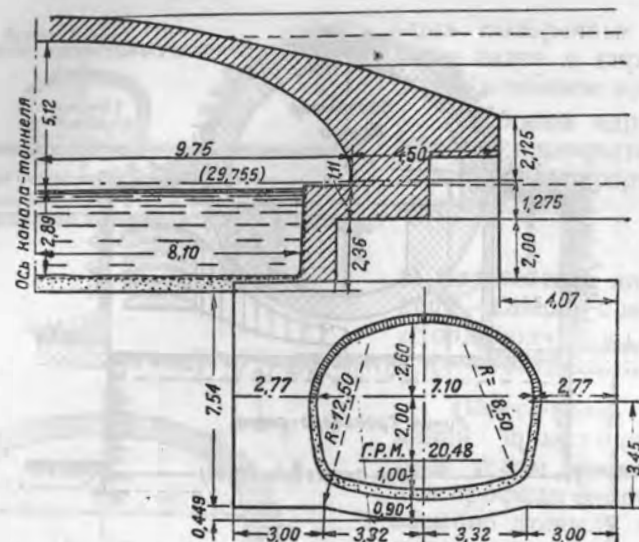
Конструкция пересечения тоннеля метрополитена линии № 9 с тоннелем-каналом „Сан-Мартен“.
